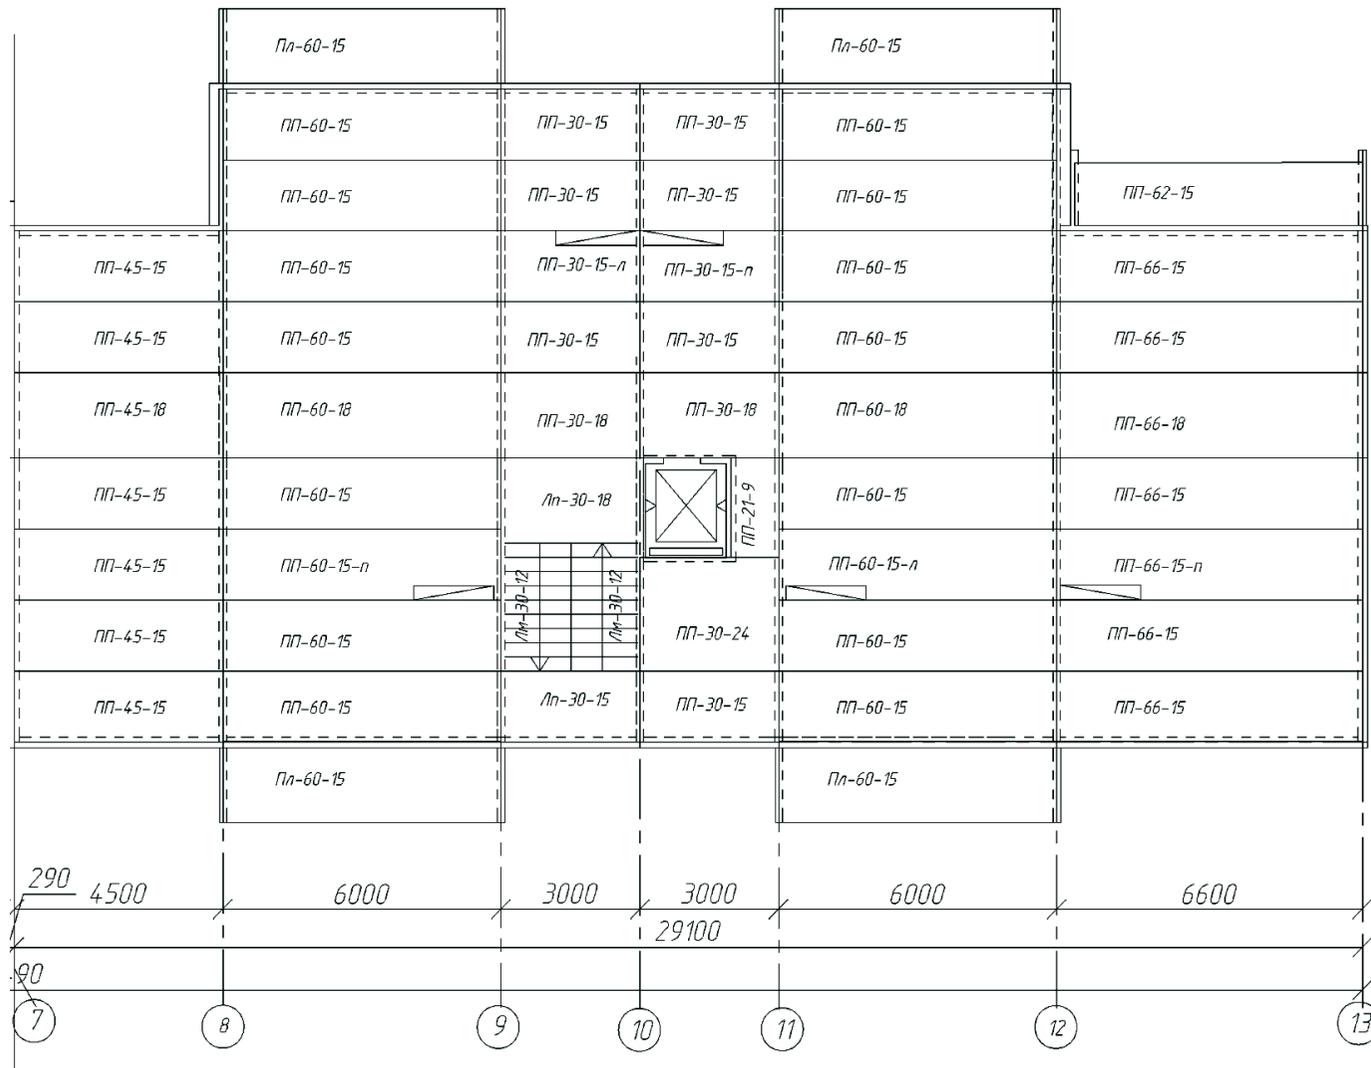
Фрагмент схемы плит перекрытия в здании с поперечным расположением несущих стен
